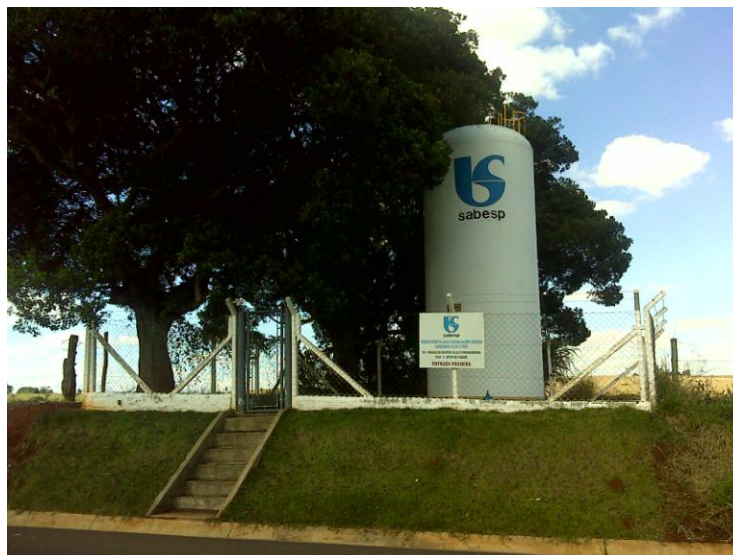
VISTA DO RESERVATÓRIO DO BAIRRO DE CERRADO
